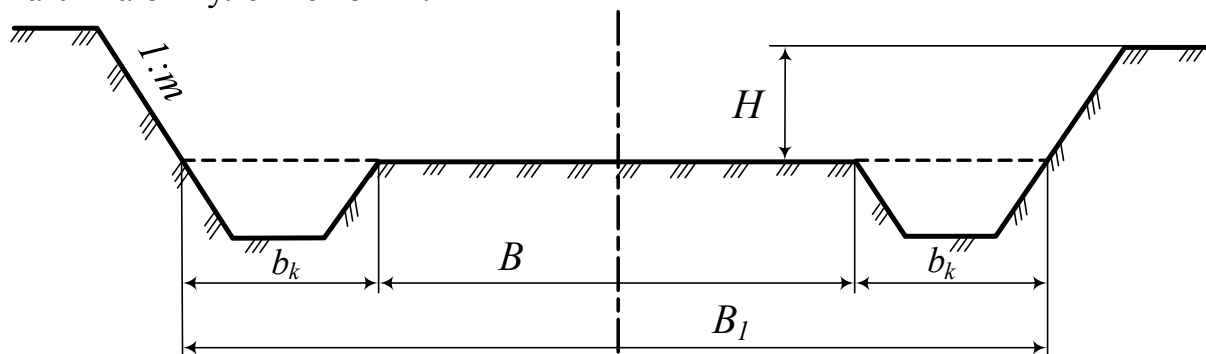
Схема к определению площади поперечного сечения выемки
